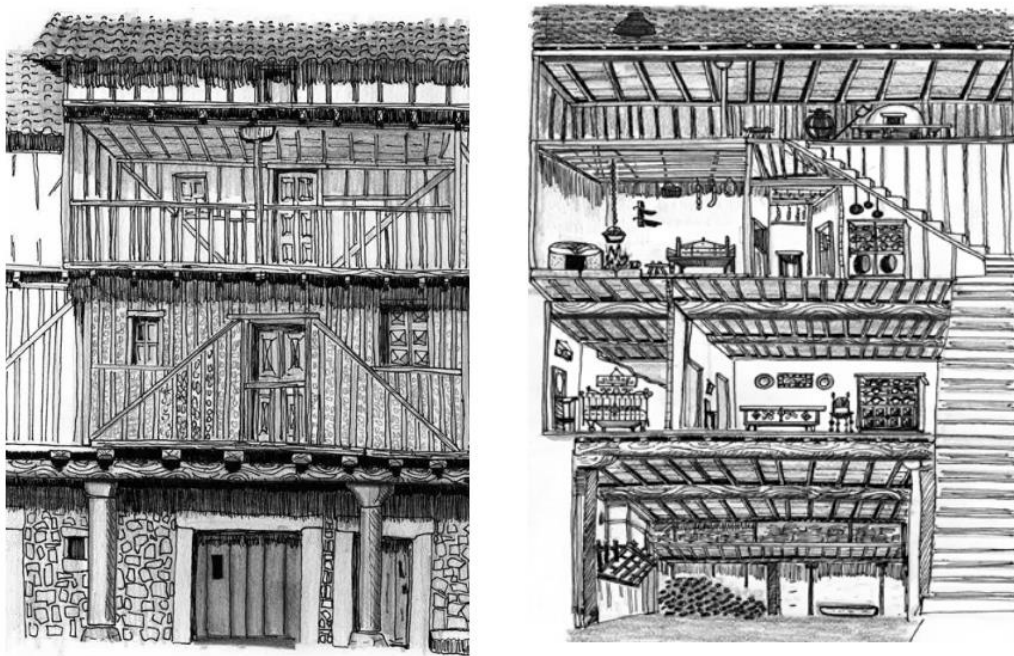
Fachada exterior e interior. Fuente: Ayuntamiento de La Alberca, 2024.
